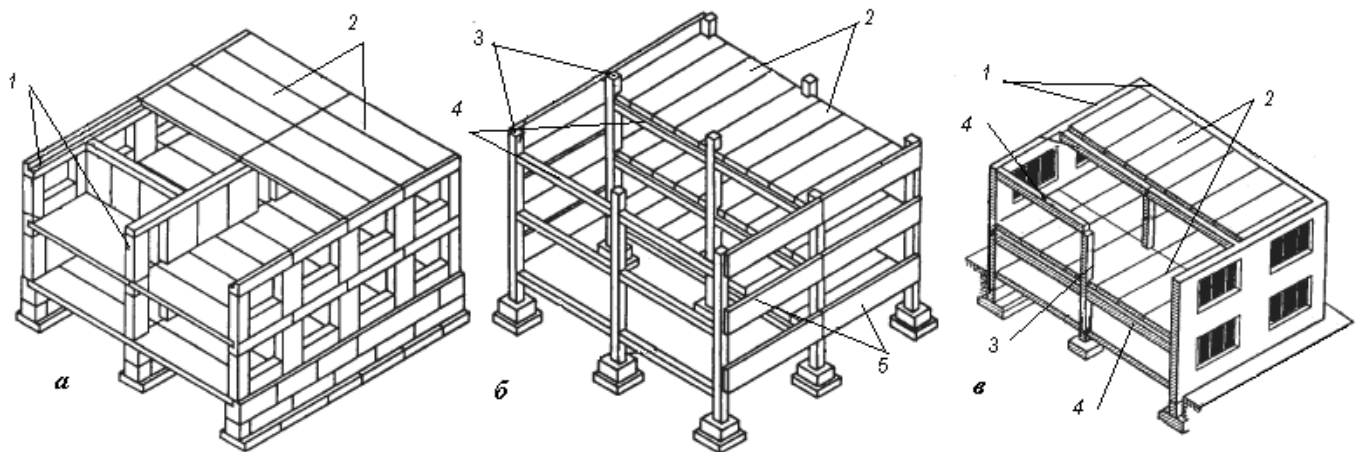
Конструктивні типи громадських будівель: а – безкаркасний; б – каркасний; в – з неповним каркасом. 1 – несучі стіни; 2 – міжповерхове перекриття; 3 – колони; 4 – ригель; 5 – ненесучі стіни
